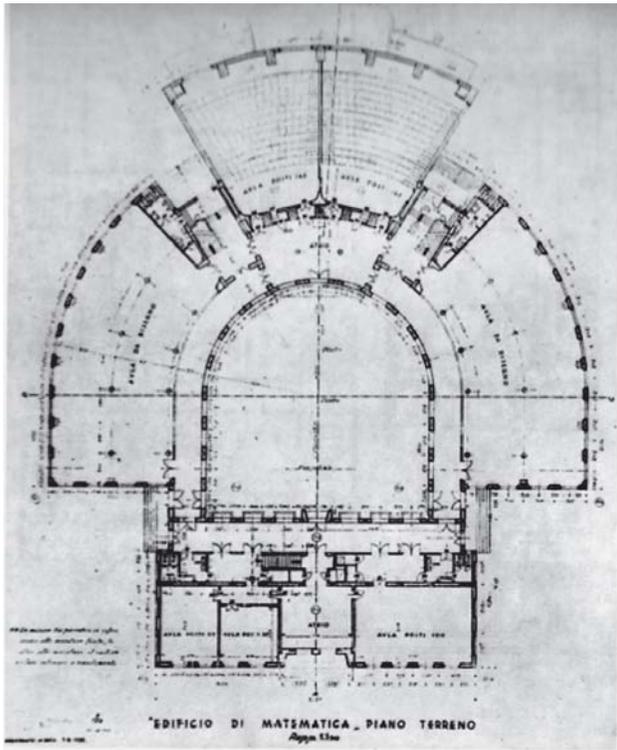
Planta do pavimento térreo (ASSUR, Patrimônio Edilício, 1935).
